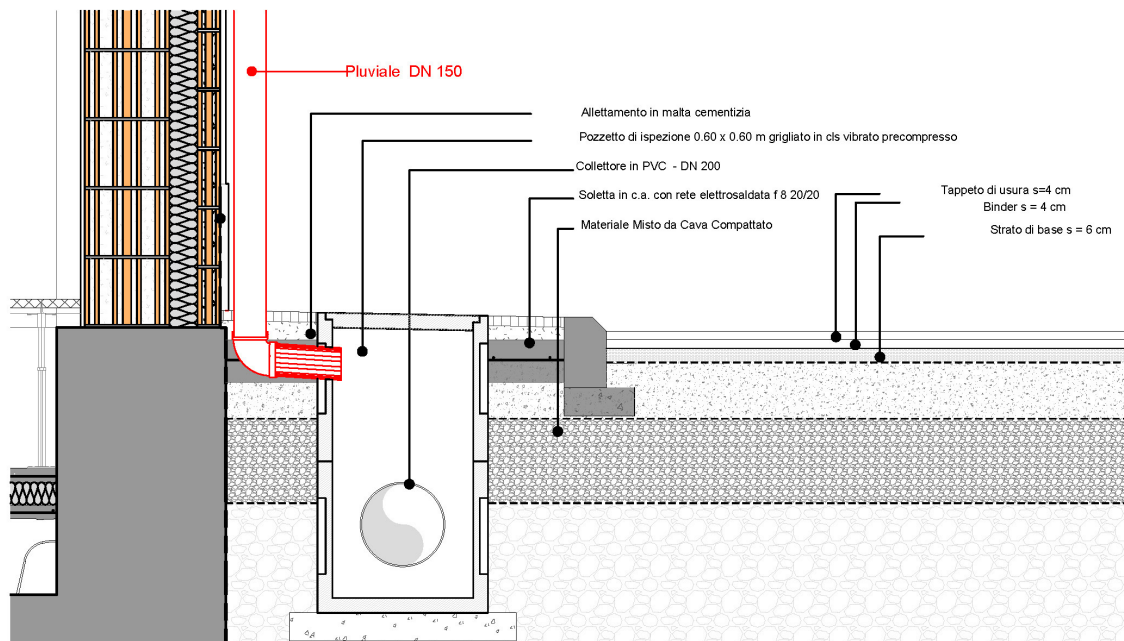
Dettaglio collegamento pluviale-pozzetto
